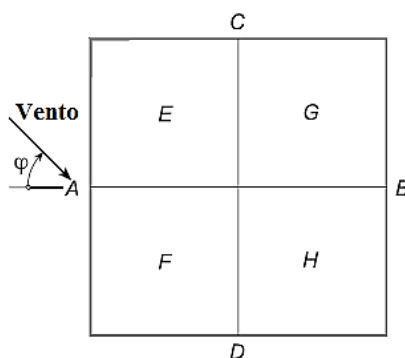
Zonamento em fachadas e coberturas (RSAEEP e SIA 261)
